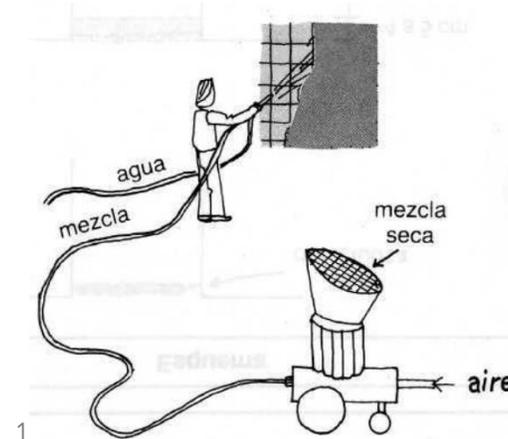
Técnicas de reparación y refuerzo de estructuras de hormigón armado y albañilerías
